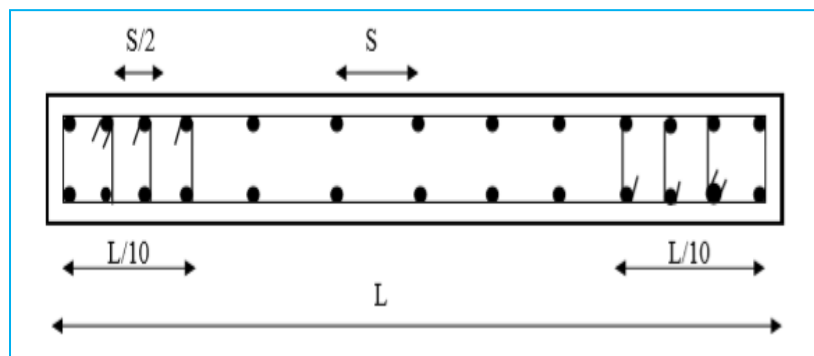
Disposition des armatures verticales (vue en plan)
